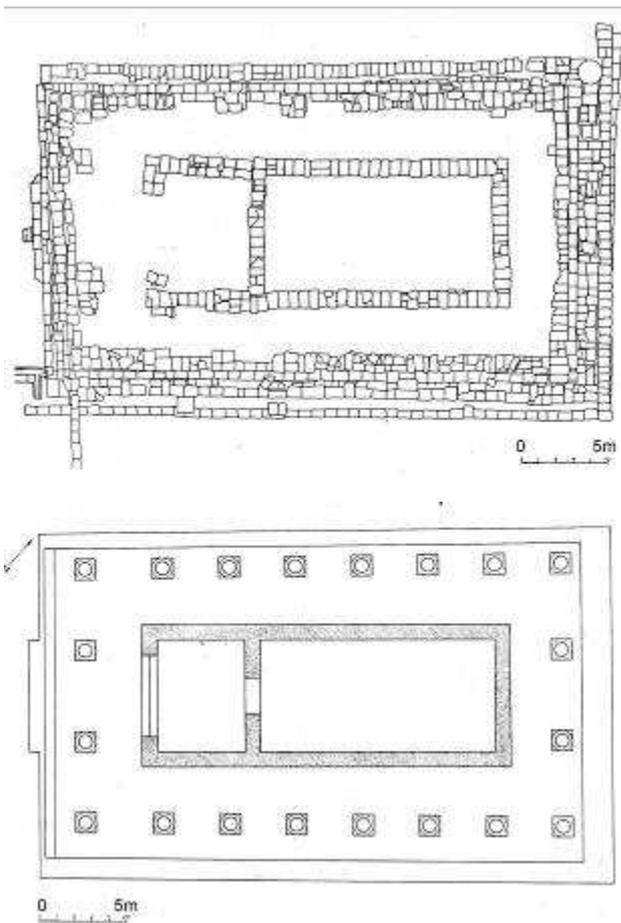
Satricum. Tempio recente. Planimetria dei resti conservati e pianta ricostruttiva (CHIARUCCI - GIZZI 1985)
